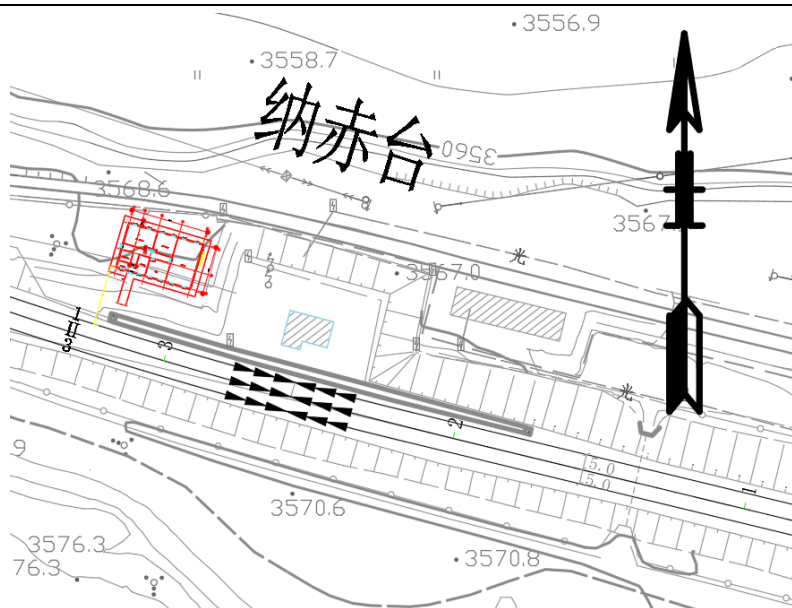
纳赤台站新建信号综合楼平面布置示意图（典型）
